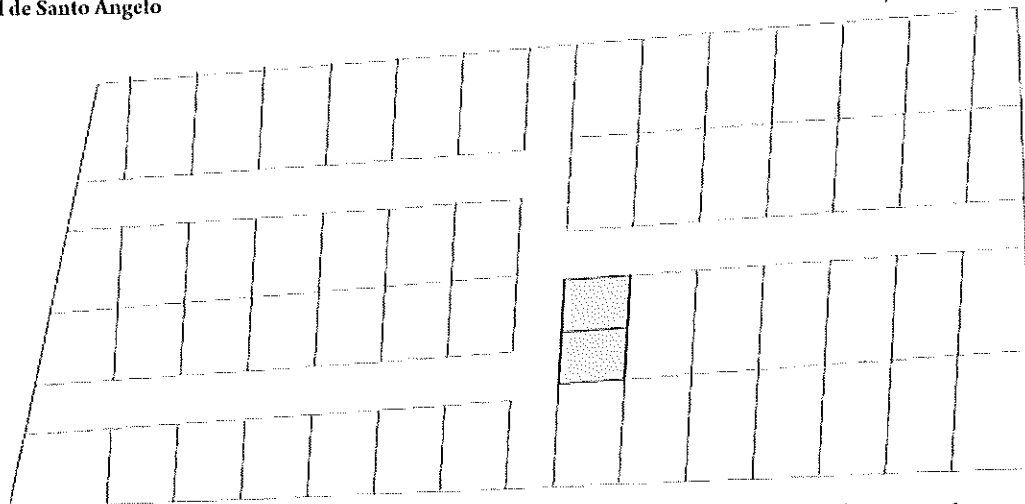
Exemplo de Fracionamento (lotes já existentes são fracionados – subdivididos – observadas as dimensões mínimas)
